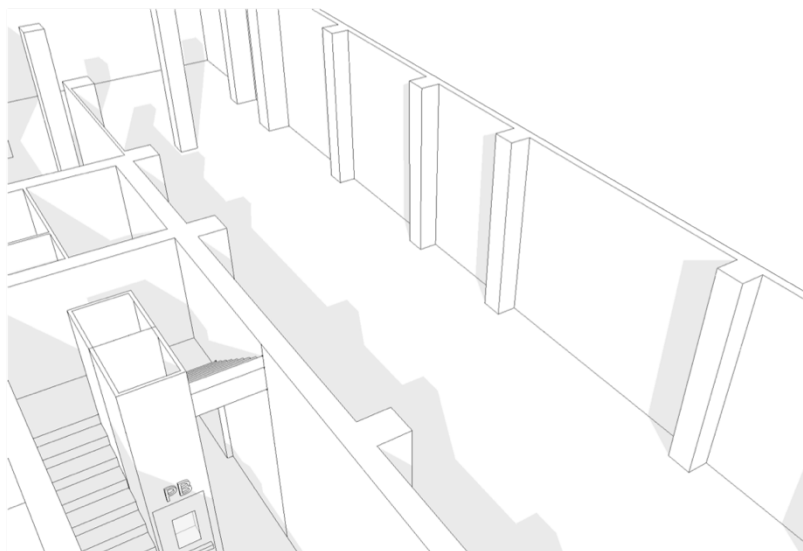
Planta baja del edificio ED-02. Nervado de columnas para arriostamiento de muros (fuente: elaborado por el autor)
